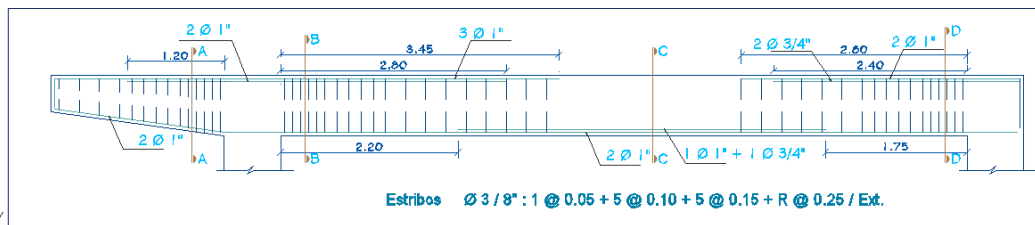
Esquema de la viga principal Pabellón 1B.
